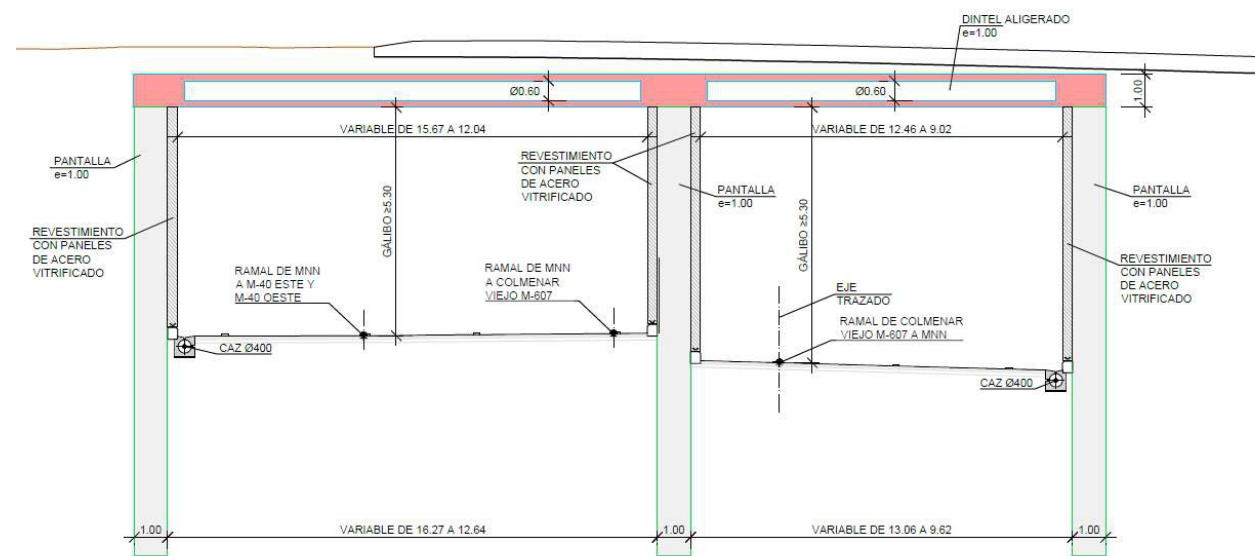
Sección tipo con muro intermedio y dintel aligerado de 1.00 m. Falso túnel Sur (1A, 2A y 3A)
